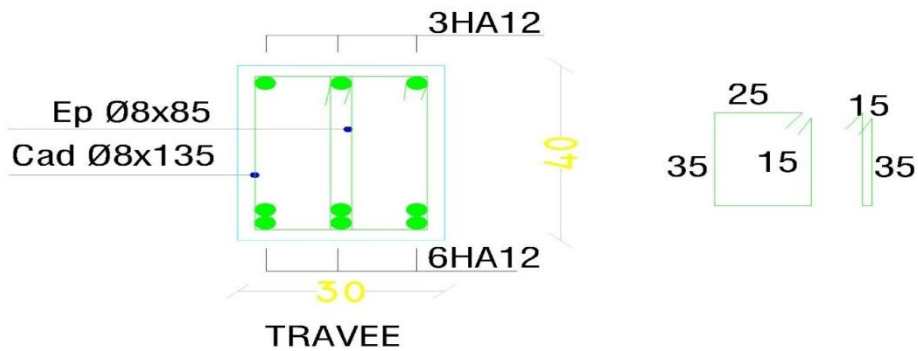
Ferrailage de la poutre principale au niveau terrasse, en travée
